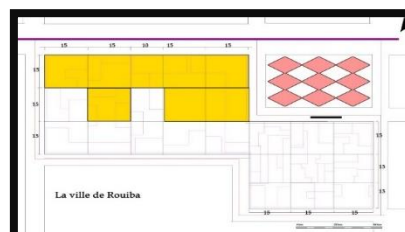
Plan des parcelles donnant sur la voie primaire
